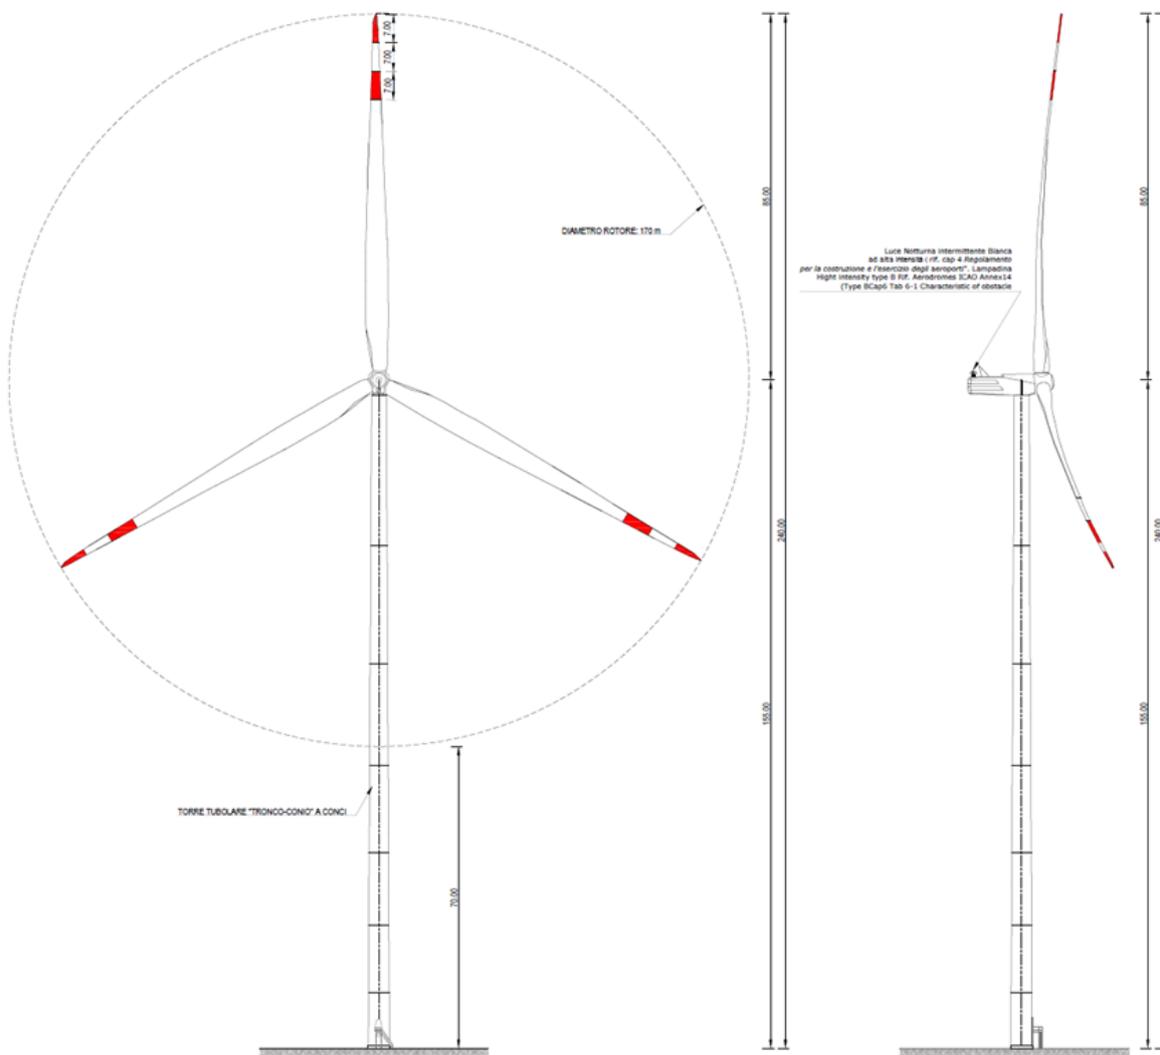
Vista prospettica e laterale dell'aerogeneratore SIEMENS GAMESA SG 6.6- 170.
